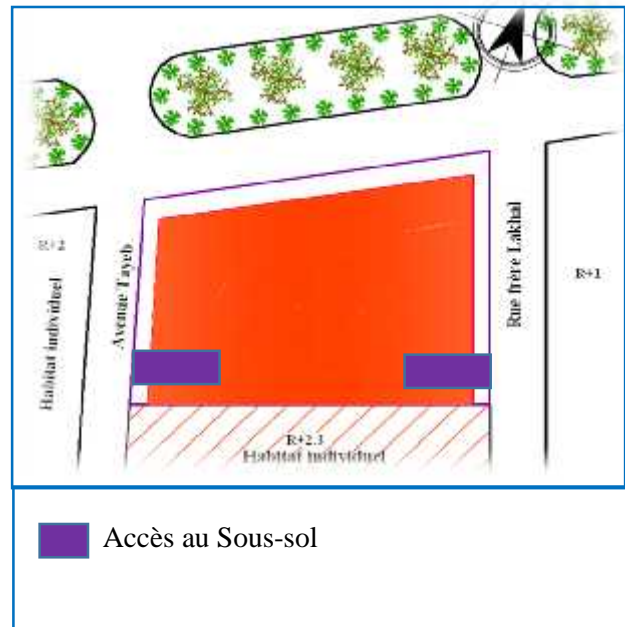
Schéma : Niveau Sous-sol (parking)
